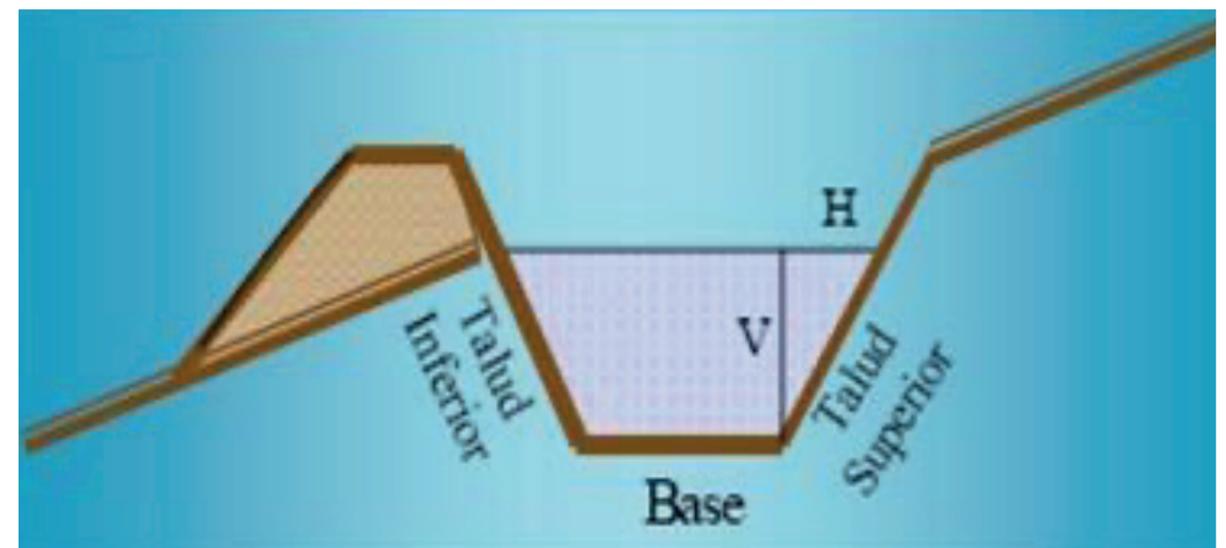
Zanjas de infiltración en Chile, restauración de áreas degradadas
